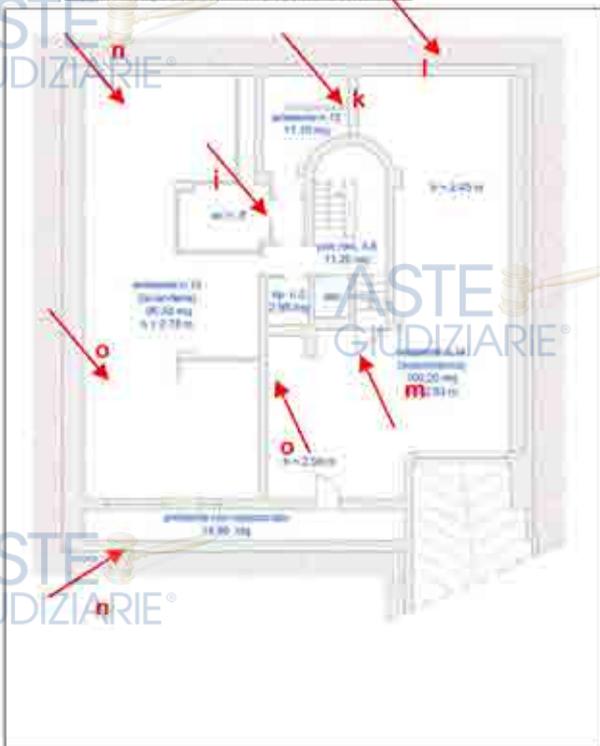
Planimetria stato dei luoghi 2°P del 17/06/2021
